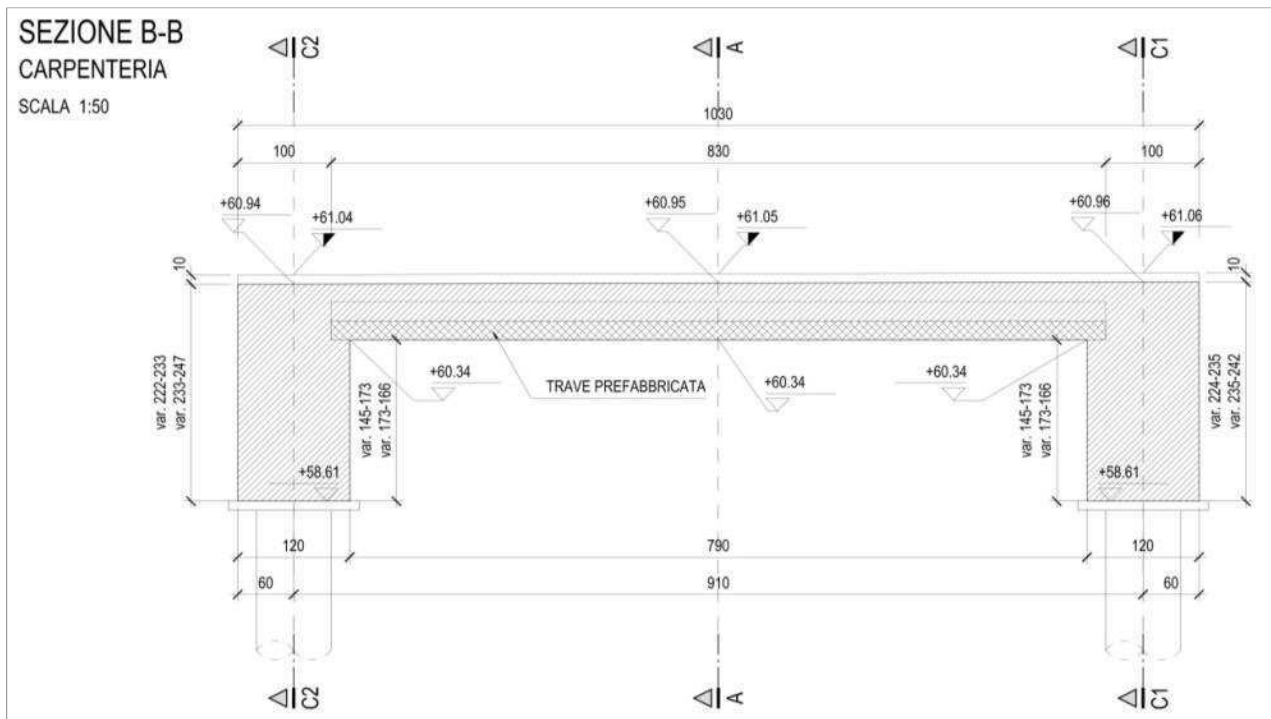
Sezione longitudinale – Ponte Asse Principale.
